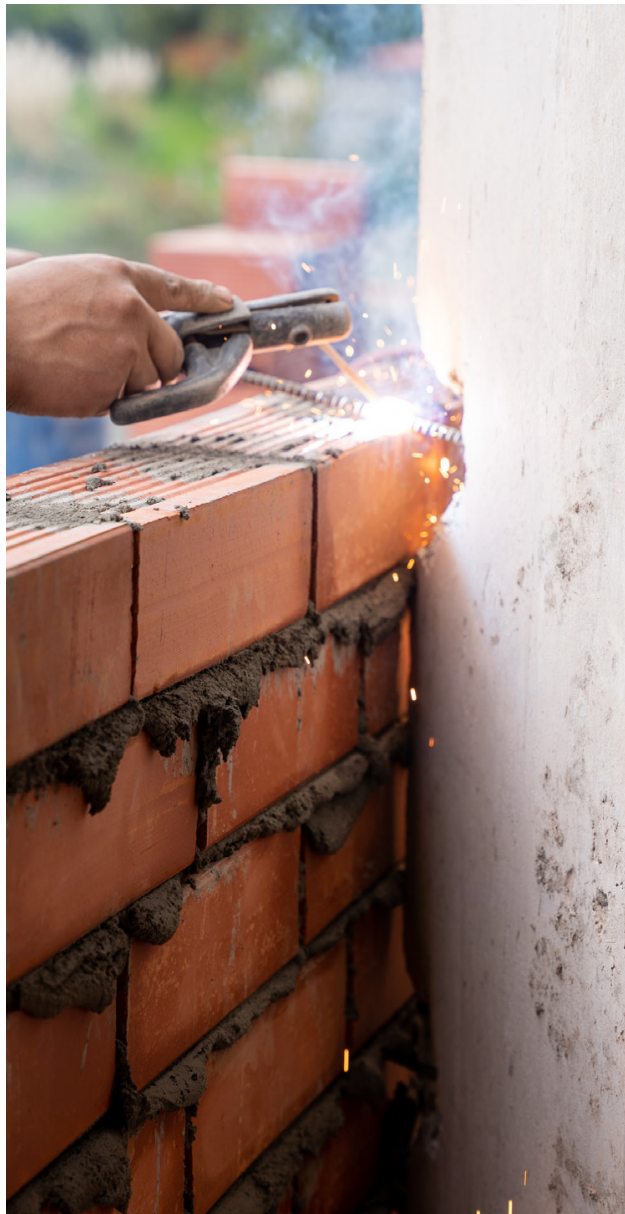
Proceso constructivo tradicional de mampostería de ladrillo
